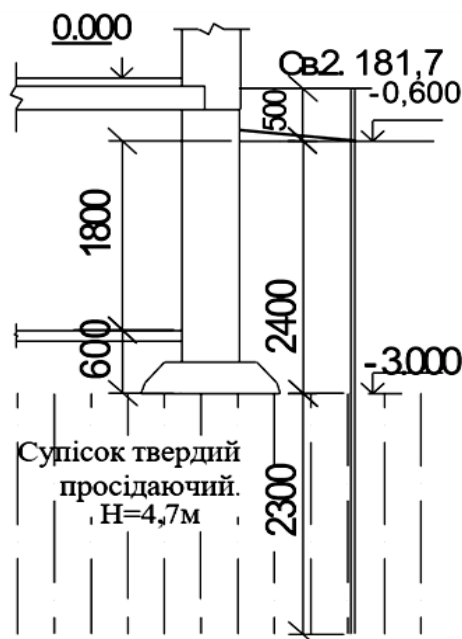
Вертикальна прив'язка фундаменту по осі 8
